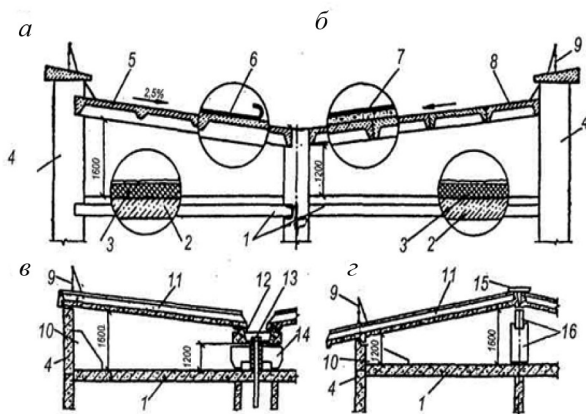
Конструктивні схеми залізобетонних дахів з холодним горищем:
